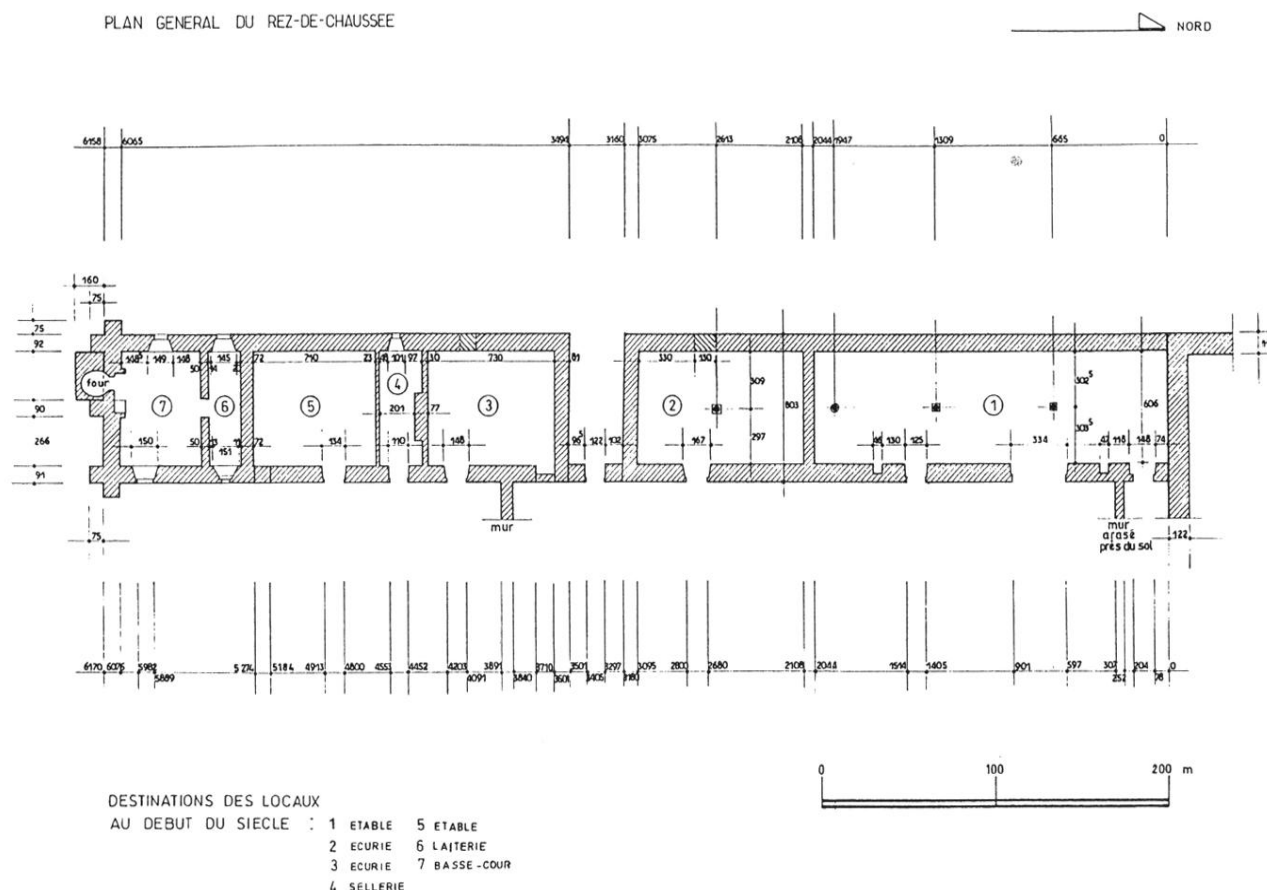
Plan de la grange au rez-de-chaussée. (Dessin : H. Rezza Doc. C.R.M.H.)
